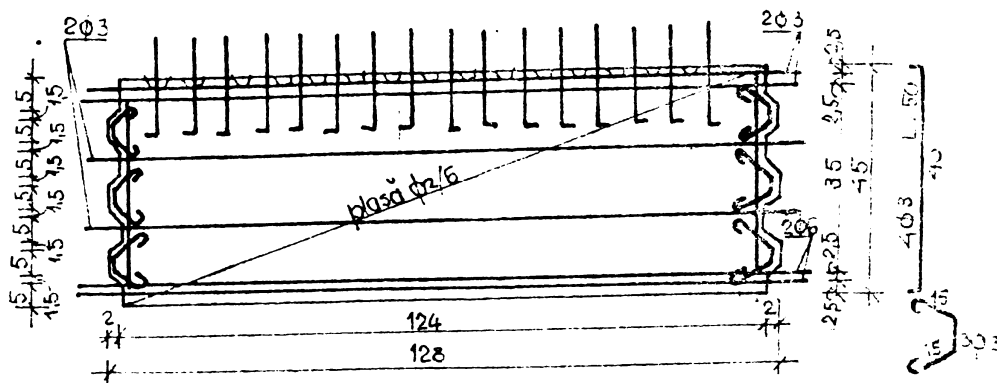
Armarea panourilor longitudinale pentru elevații.
